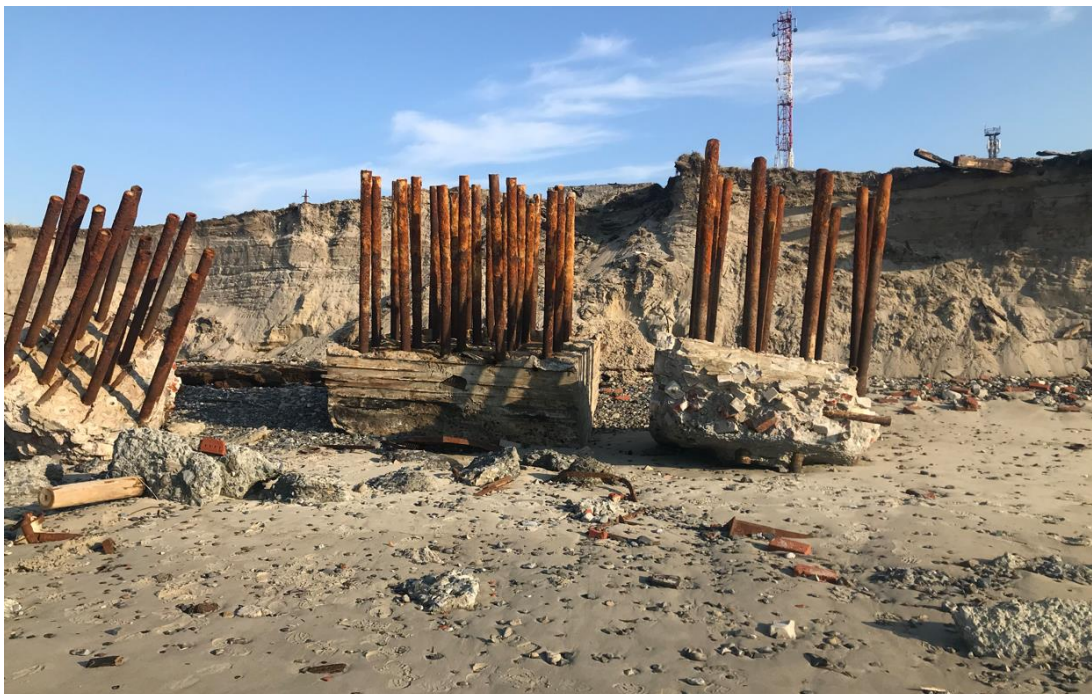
Свайные основания здания, вывернутые из грунта и спроецировавшиеся на пляж в результате береговой эрозии
